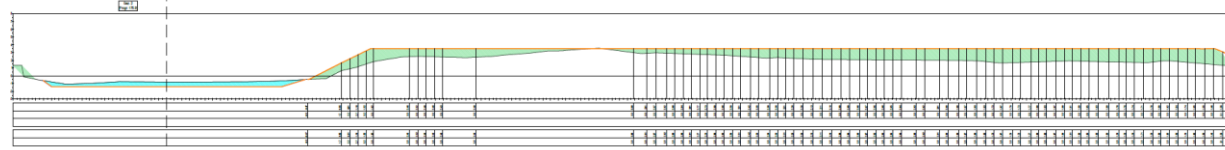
Planimetrie e sezioni d'intervento (stralcio da elaborati progettuali)
